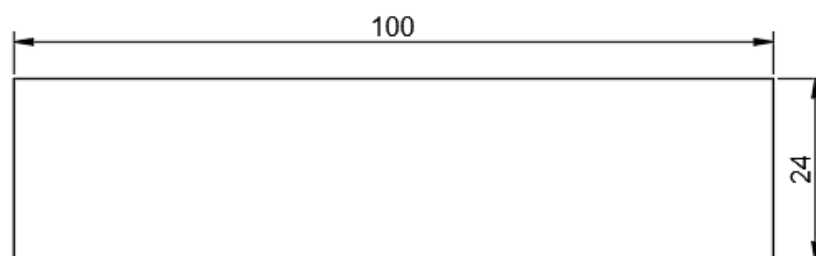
Sección de la losa para las barras transversales (cotas en cm)
